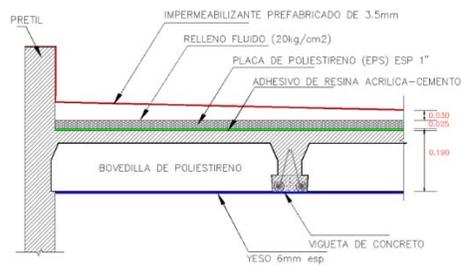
Corte de sistema de aislamiento en losa de vigueta y bovedilla.
